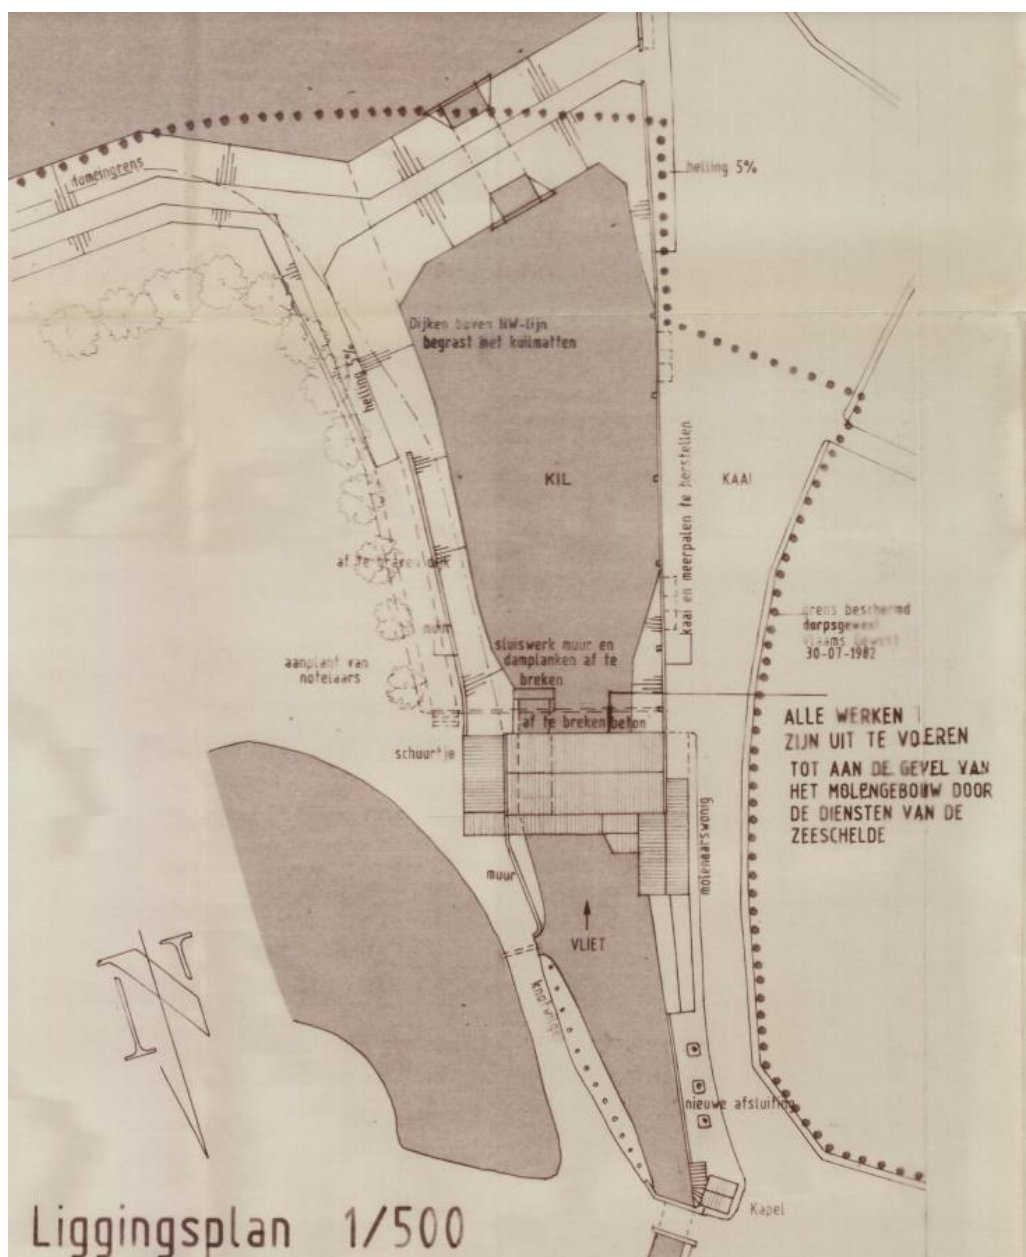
Liggingplan uit 1986 waarop de verschillende gebouwen benoemd staan, en aangegeven staat welke storende elementen dienden verwijderd te worden. (Archief Kruikebe, Restauratie Getijdenmolen.)
